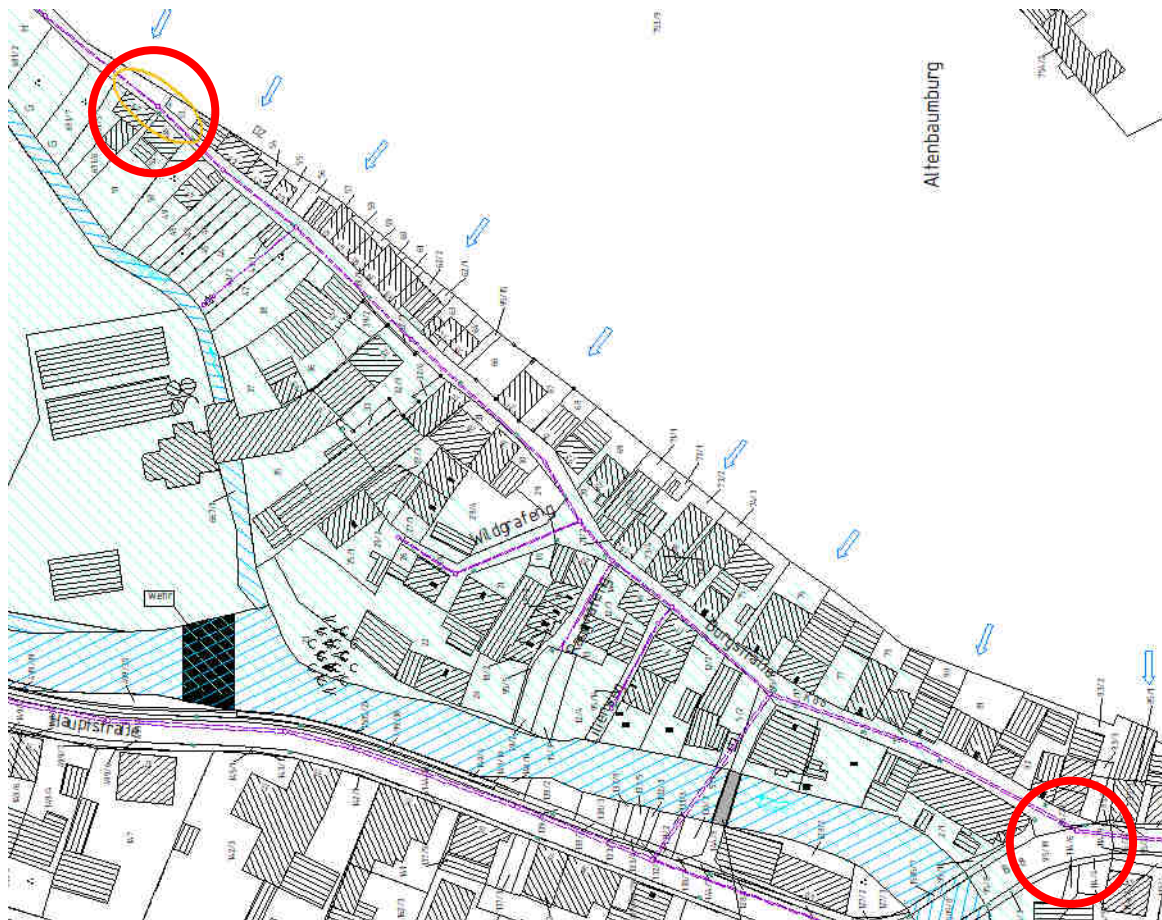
Lageplanausschnitt, Burgstraße Senke
